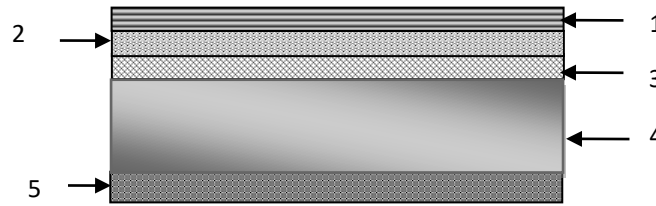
Coupe transversale dans le plancher à dalle pleine.
